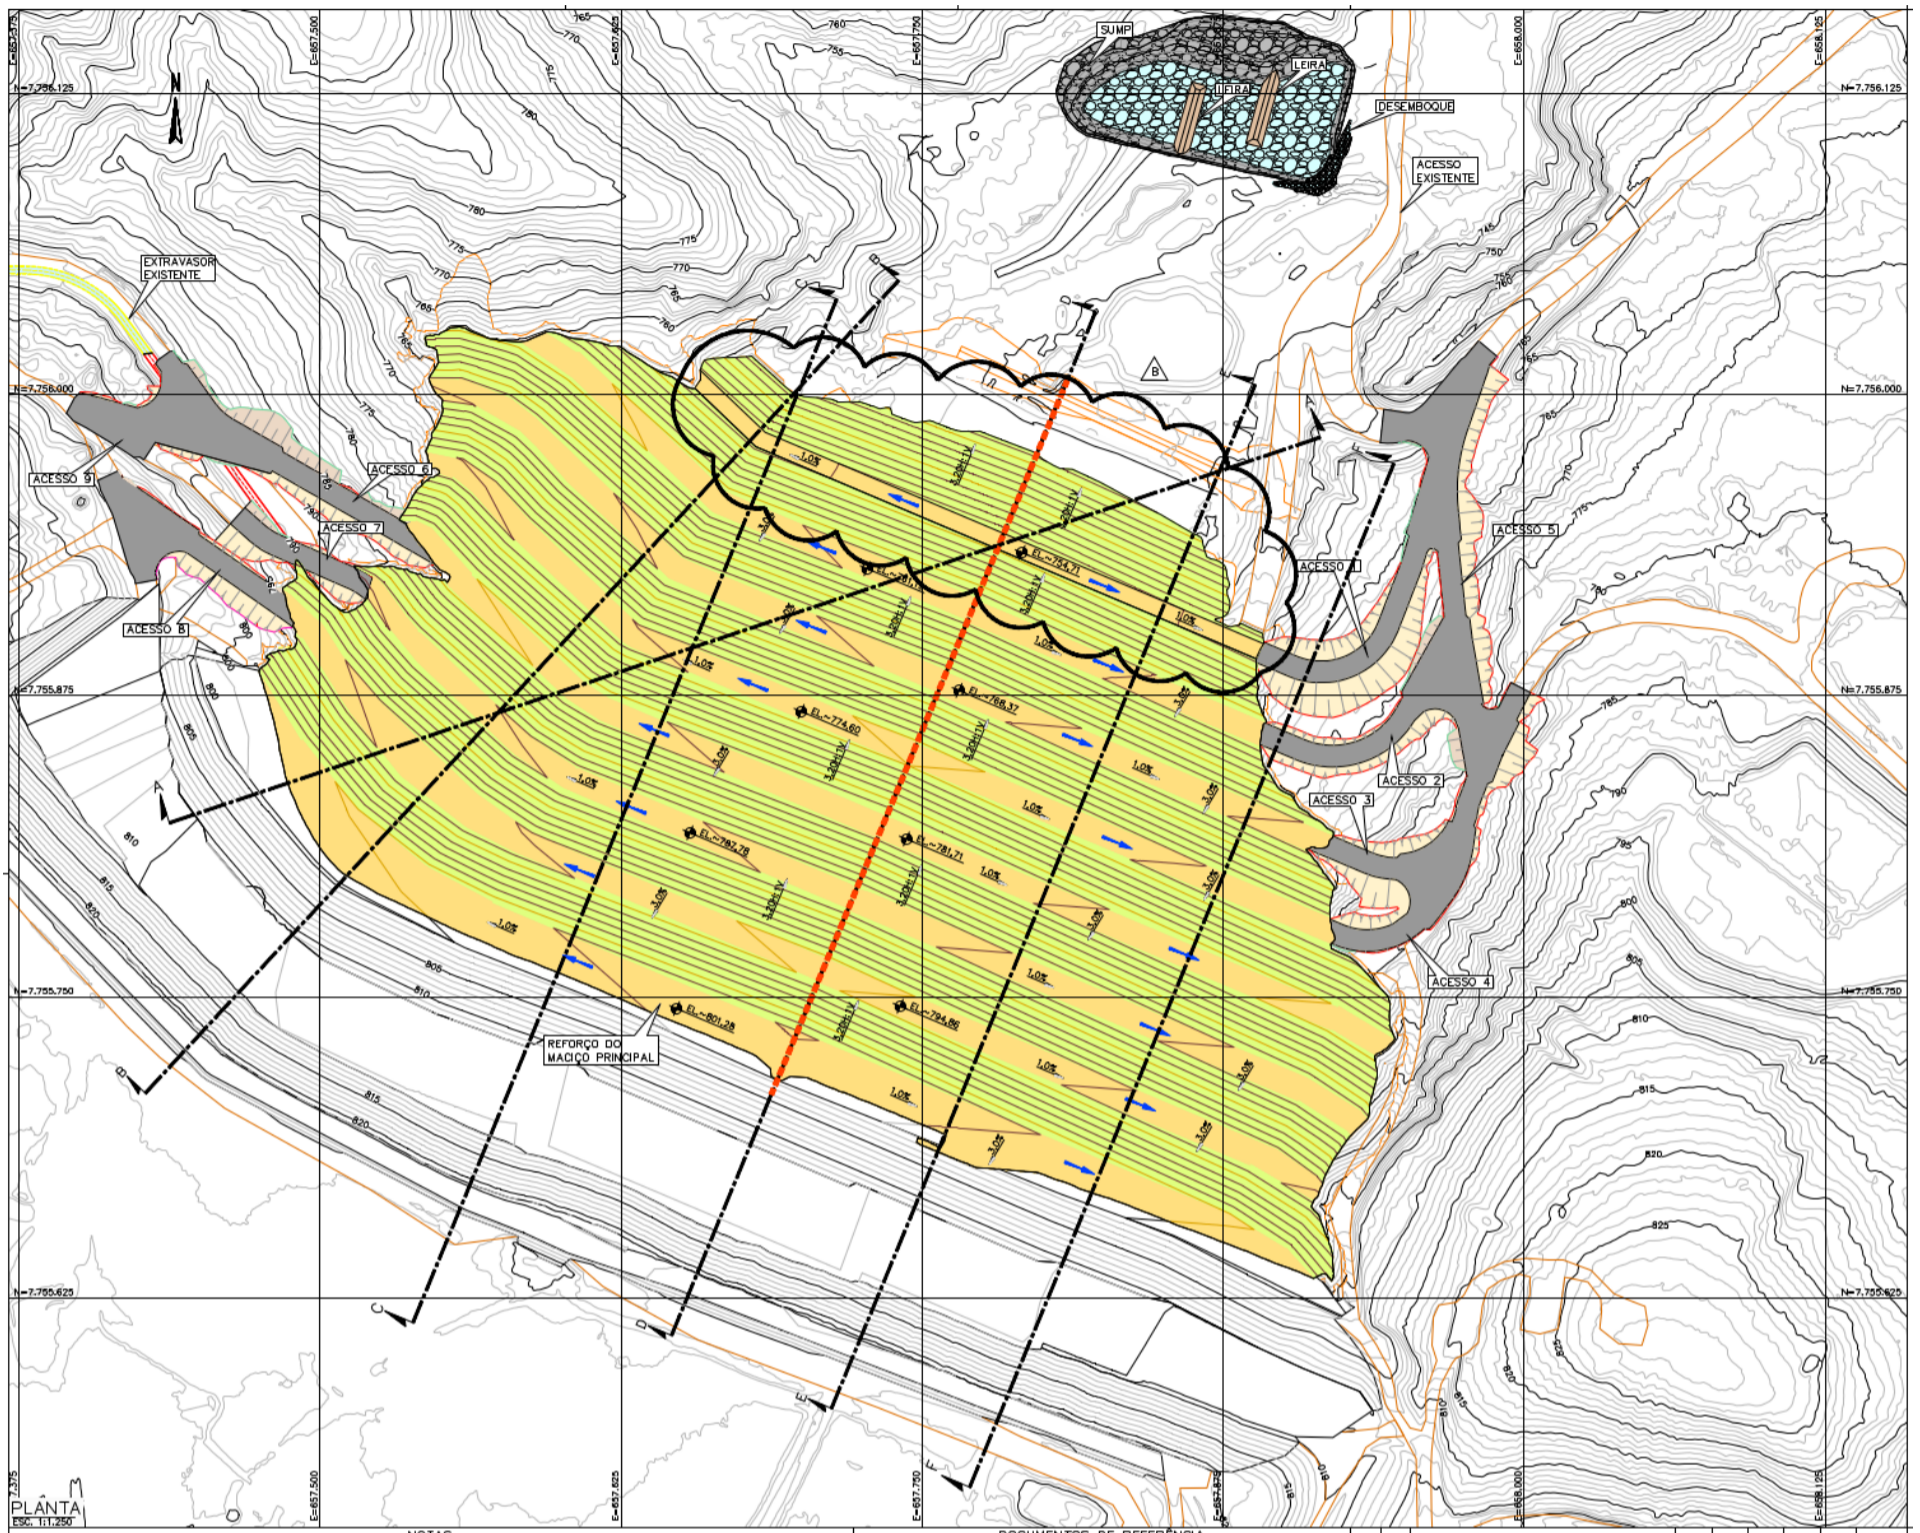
Reforço de descaracterização da Barragem Doutor – Planta.
